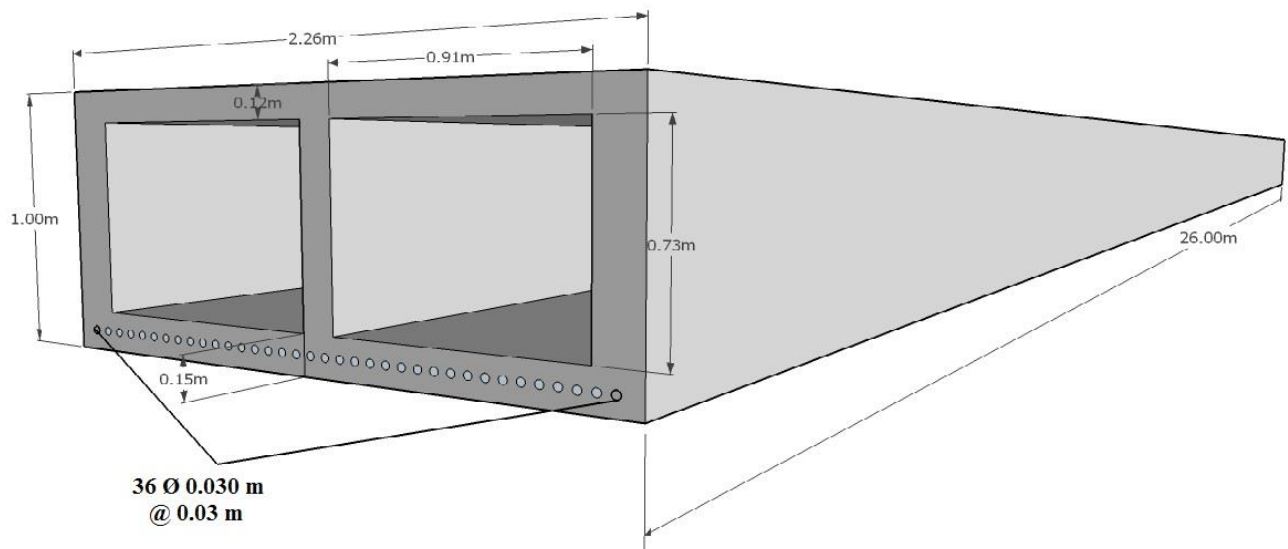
Dimensionado de la viga cajón prefabricada en pretensado.
